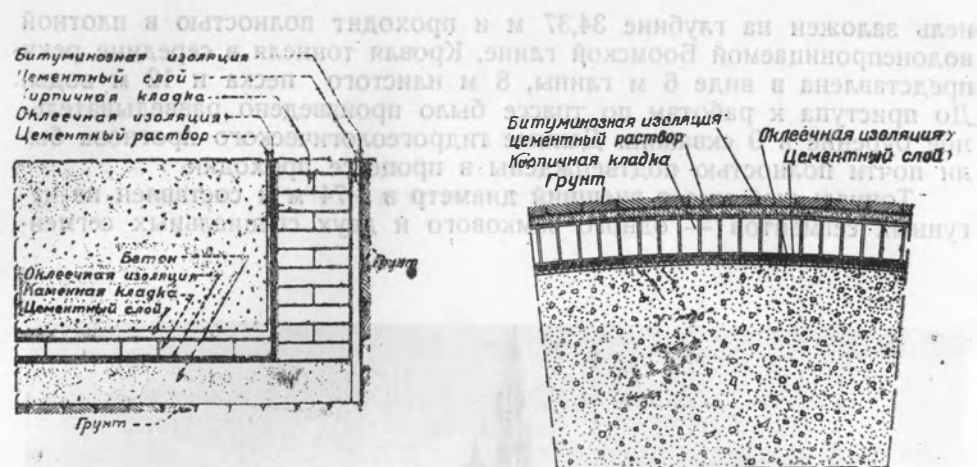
Система изоляции бетонной конструкции стен и лотка.
